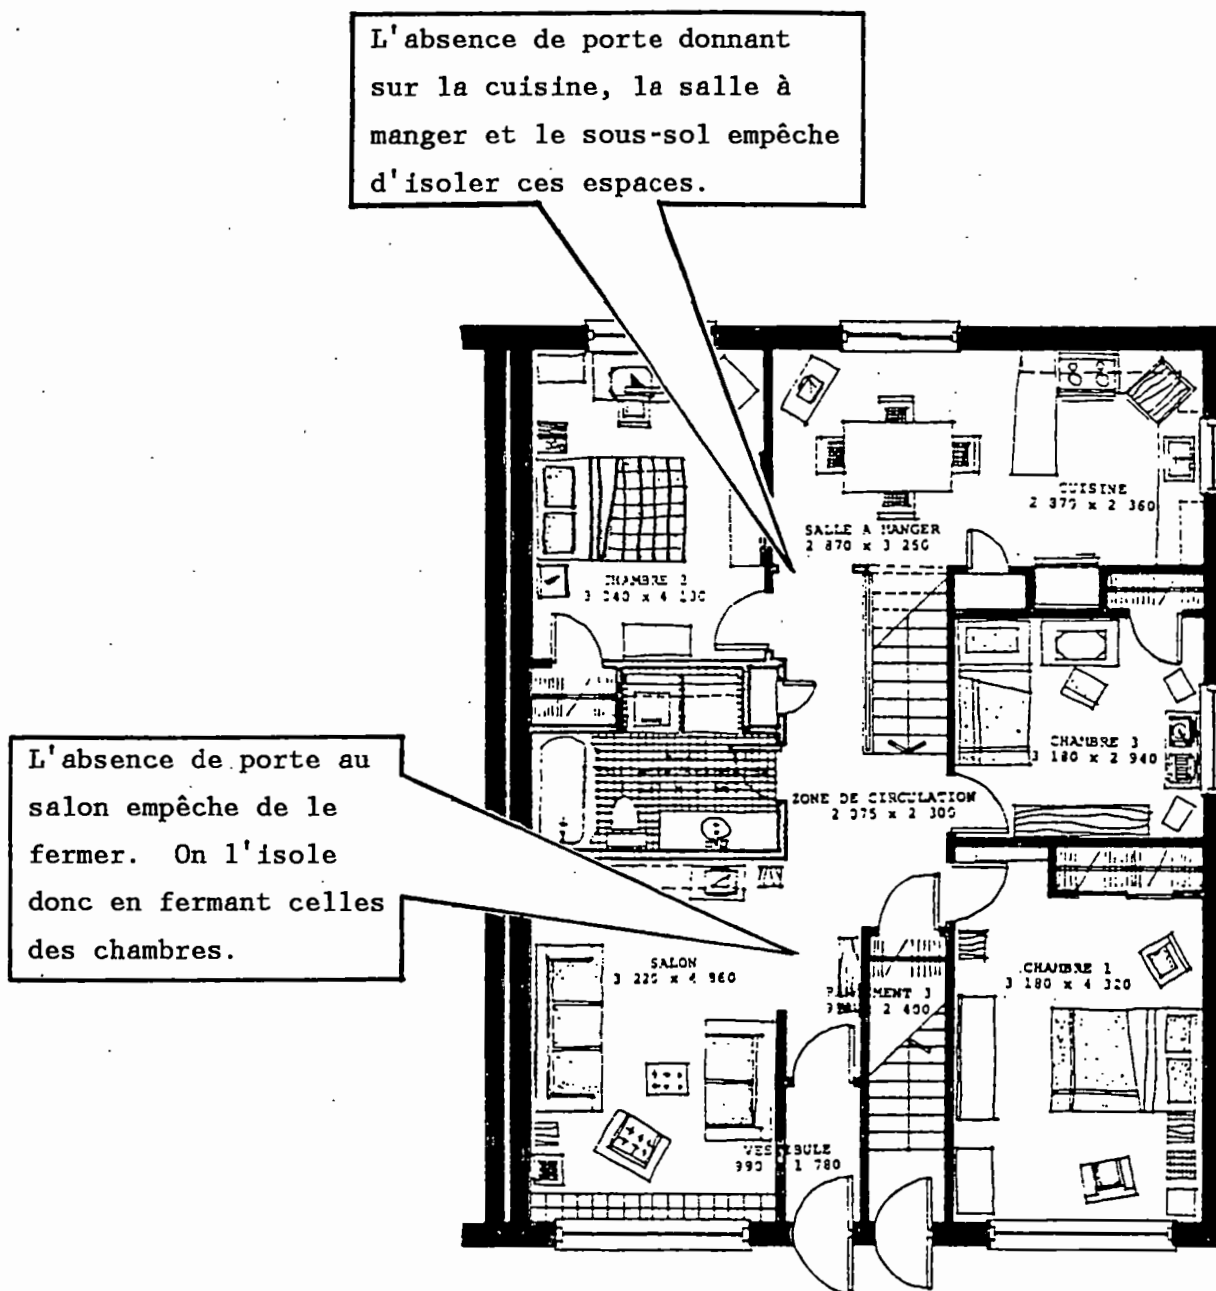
Plan du rez-de-chaussée d'un duplex, Famille 17 (1470).
